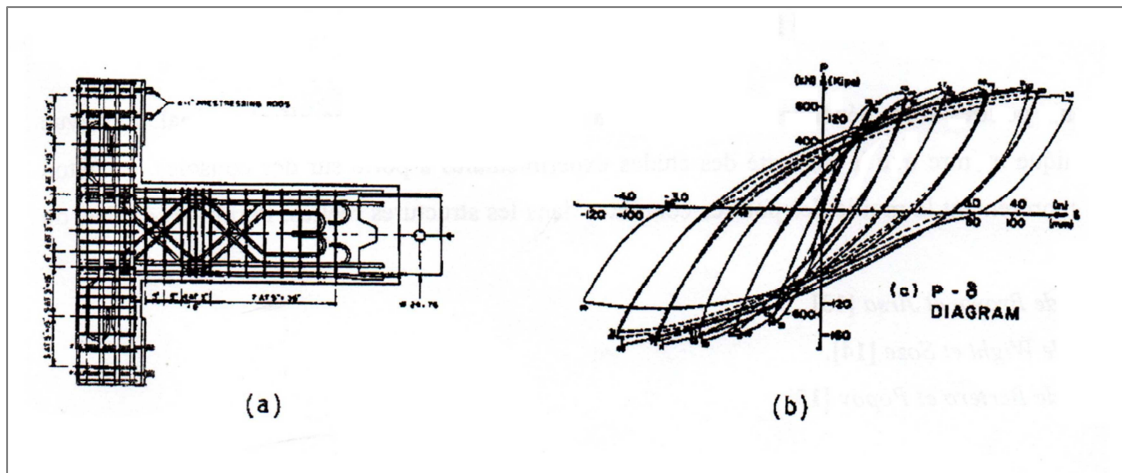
(a) Poutre avec ferrailage diagonal. (b) Boucles d'hystérésis.
